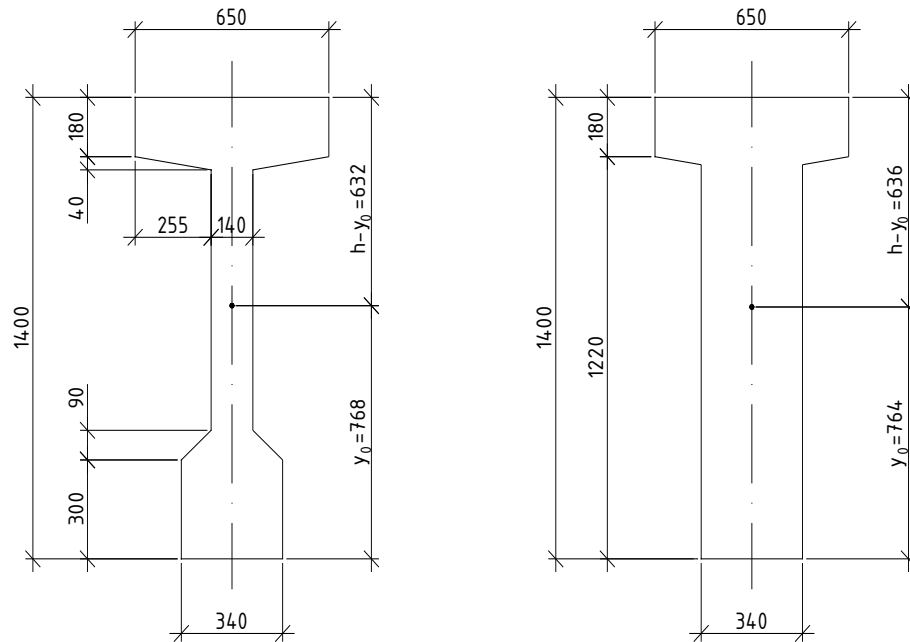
Переріз підкранової балки у прольоті та на опорі
